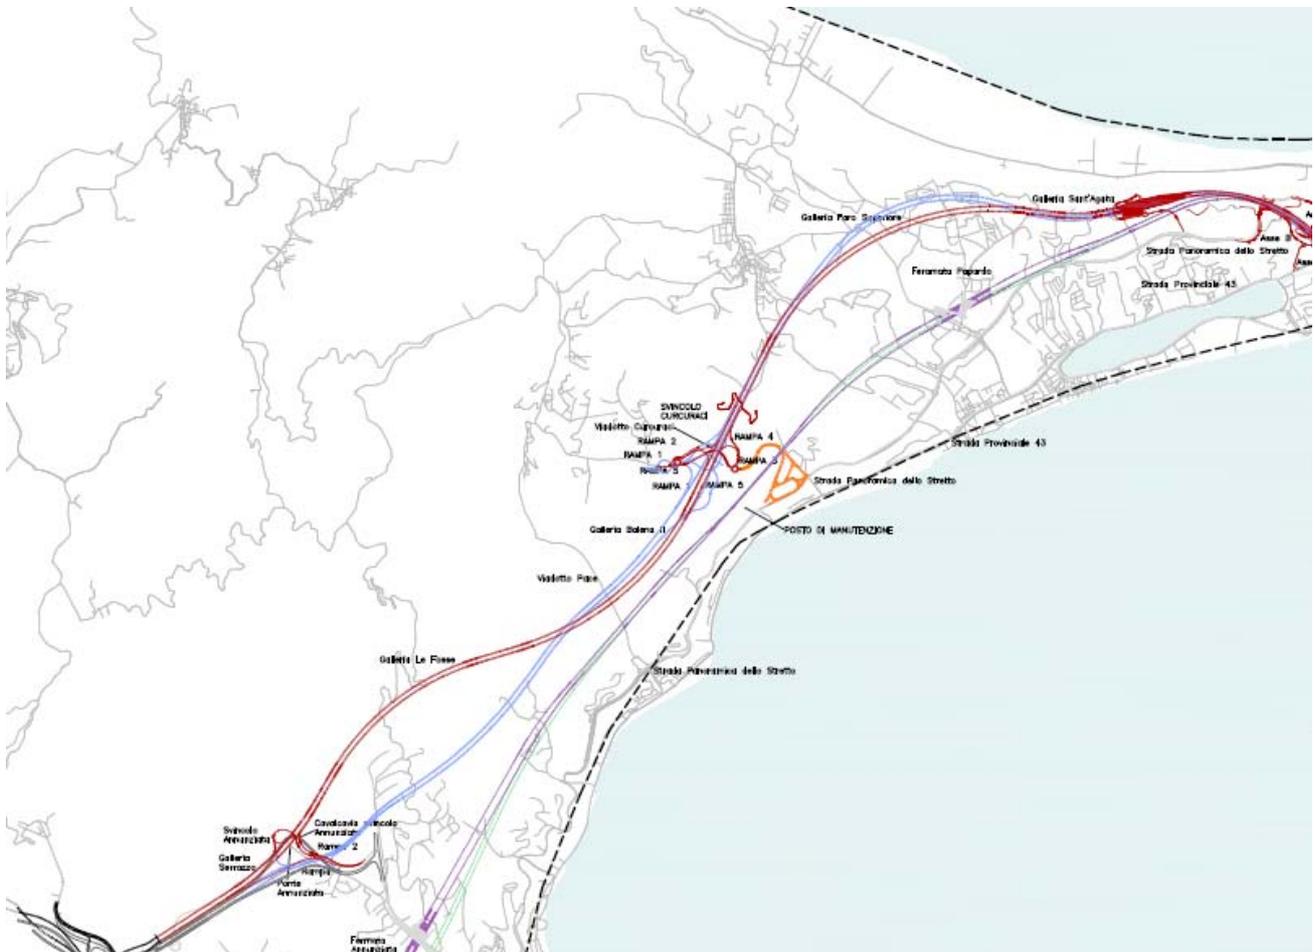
Lato Sicilia - Collegamento Stradale - Sovrapposizione tracciati PP (azzurro) e PD (rosso)
